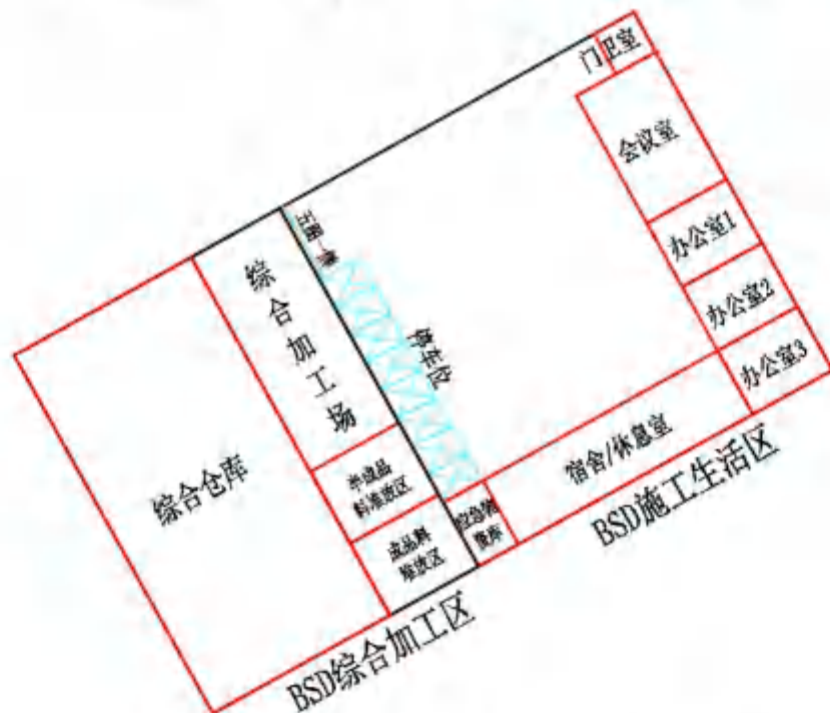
白水头南段生产生活区平面布置图
